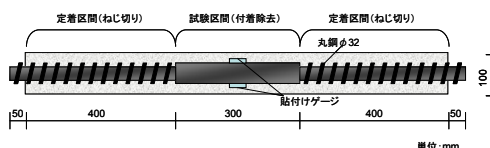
鉄筋埋設ひび割れ試験用供試体
